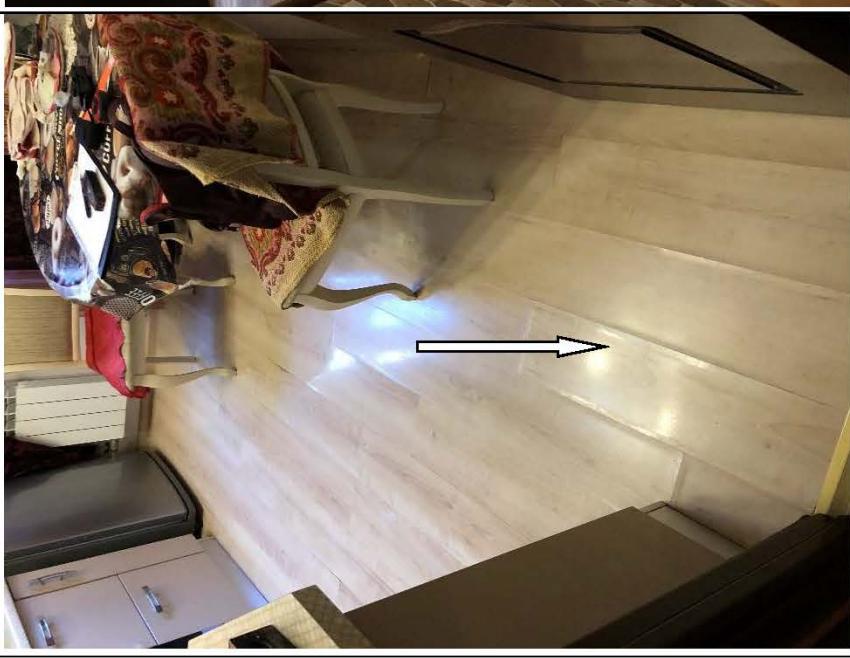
Общий вид напольного покрытия на кухне в квартире.
